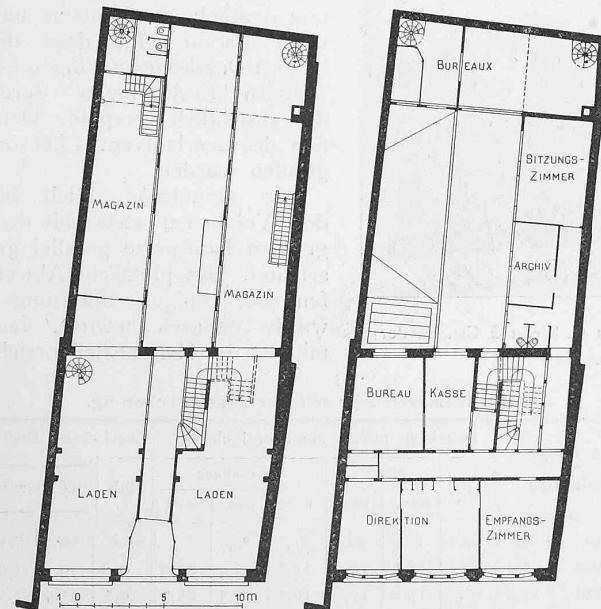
und 3. Grundrisse vom Erdgeschoss und ersten Obergeschoss des Geschäftshauses G. u. W. Baader an der Aeschenvorstadt.
